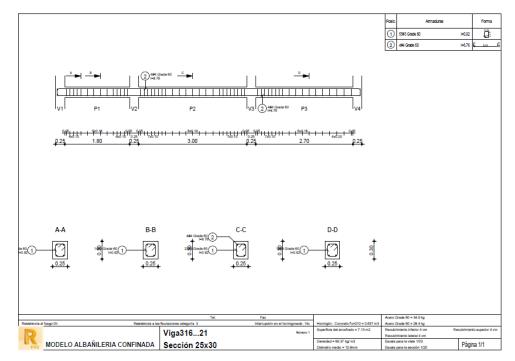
Plano de ejecución por defecto de la viga en Robot.
